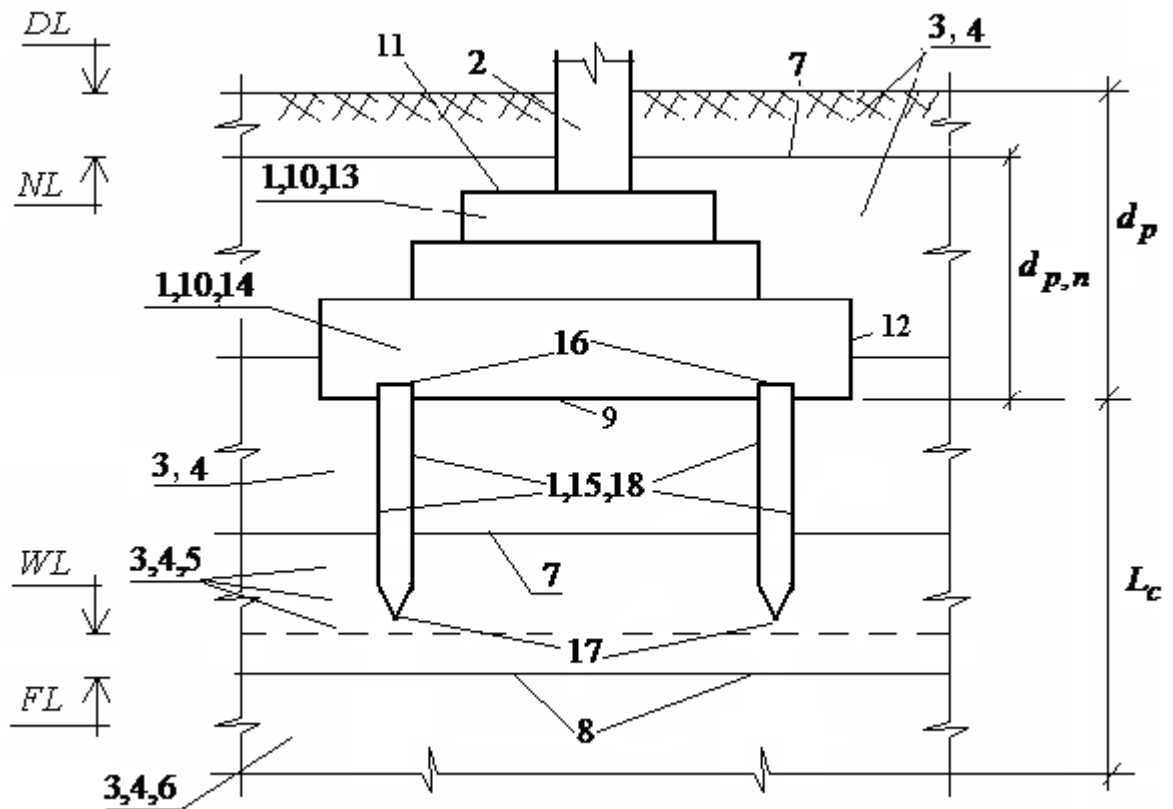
Система “Основание – свайный фундамент – надфундаментное строение” (схема).
